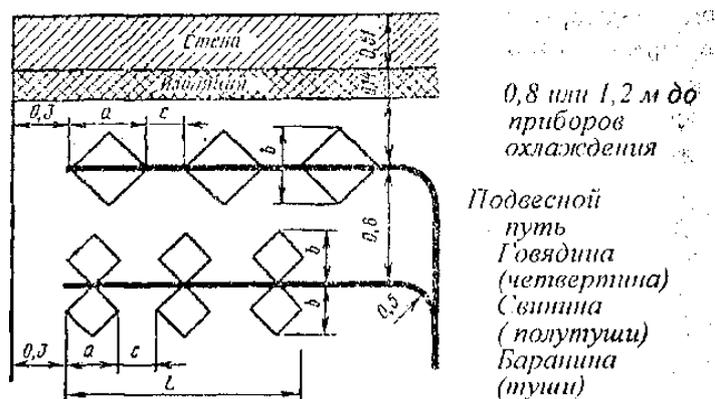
План размещения туш, полутуш и четвертин на подвесном пути:
